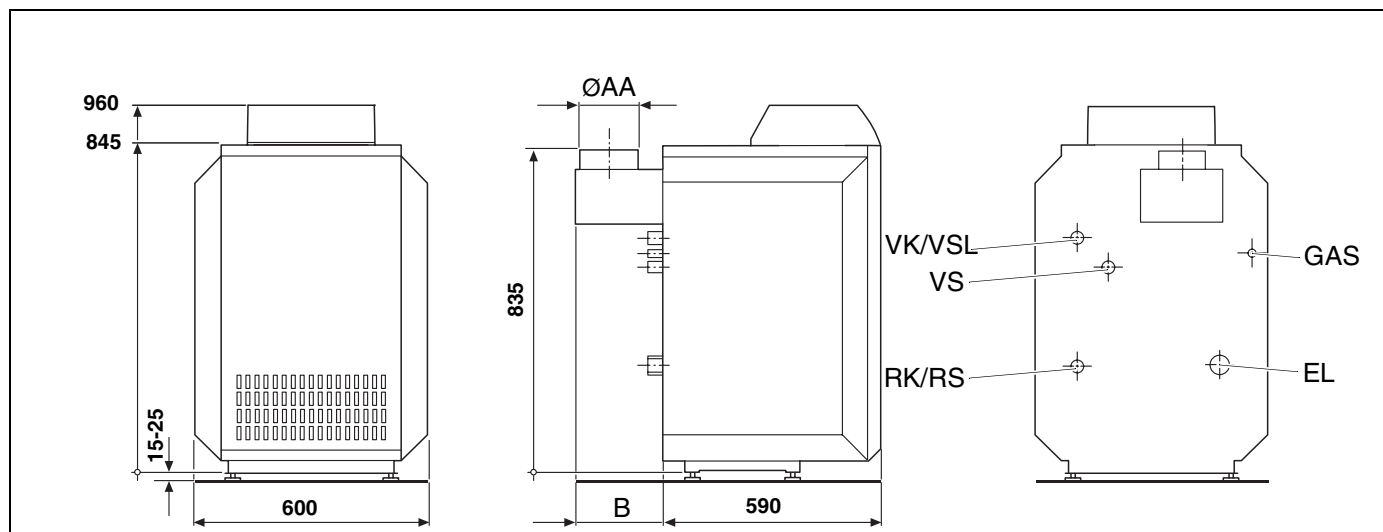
Anschlüsse und Abmessungen für G144 (Maße in mm)
